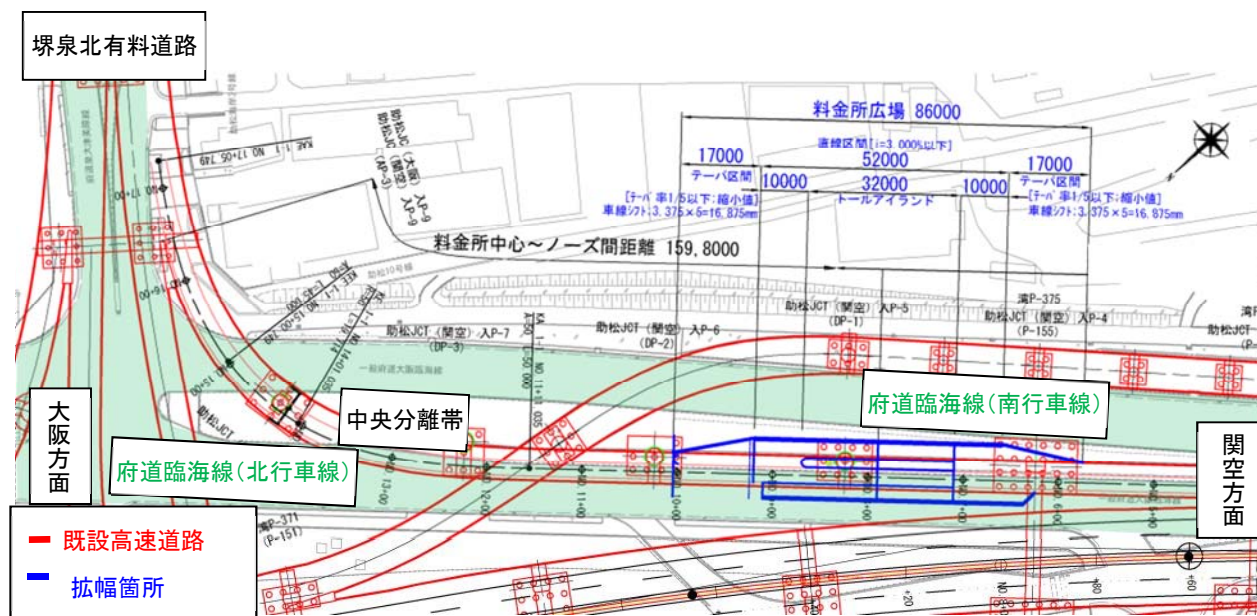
助松JCT(関空方面)料金所拡幅概要平面図
